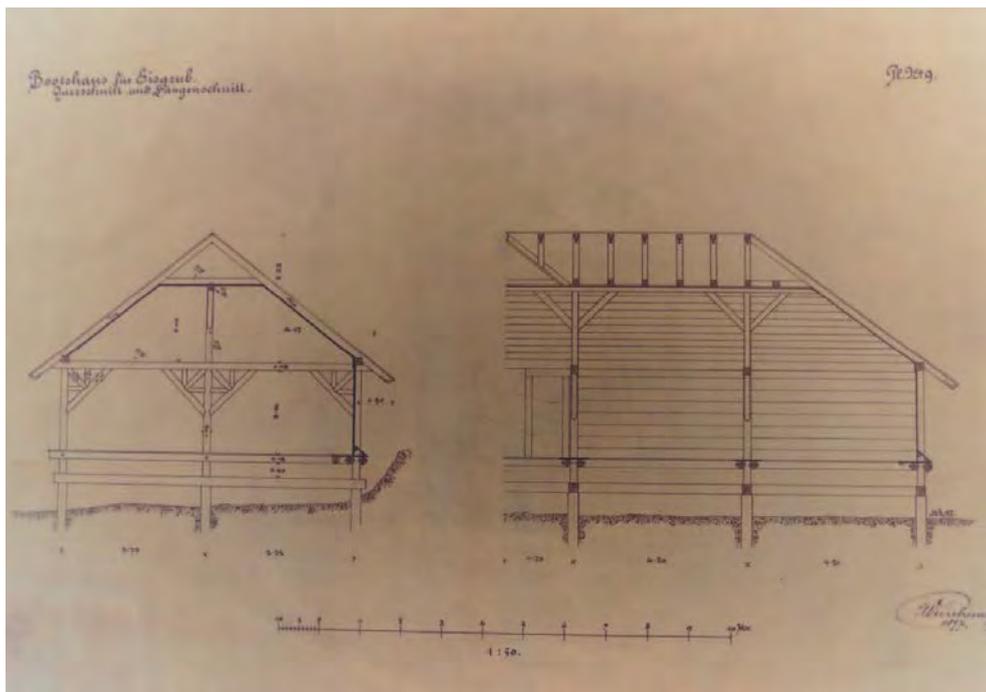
, Plan „Bootshaus für Eisgrub. Quer- und Längsschnitt.“ /
